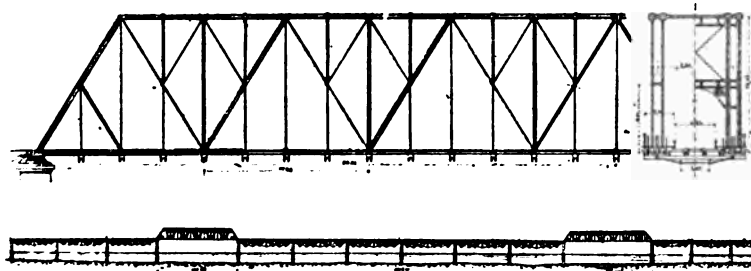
et 79. - Pont de Louisville sur l'Ohio.
